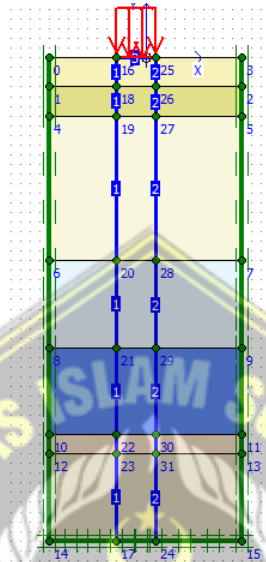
Pemodelan Fondasi Tiang Pancang
